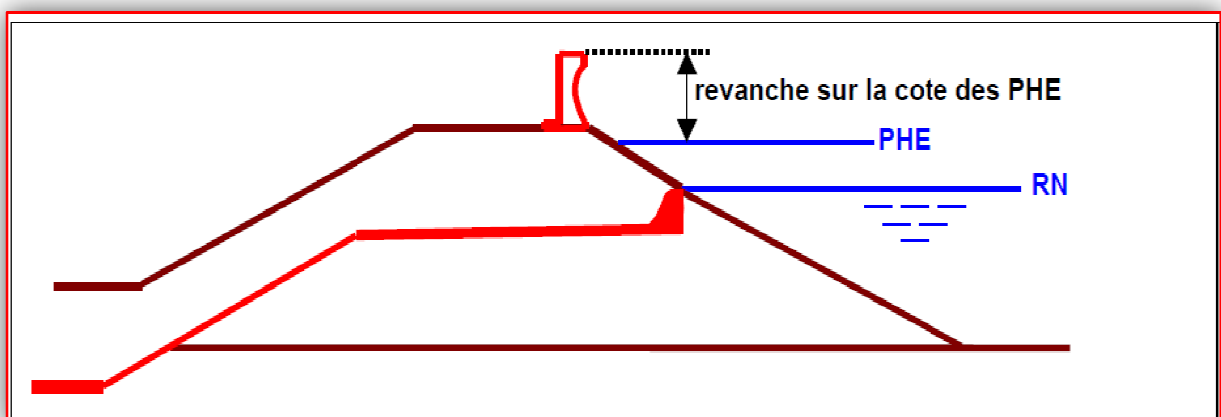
Revanche sur les PHE pour un barrage équipé d'un mur pare-vagues
